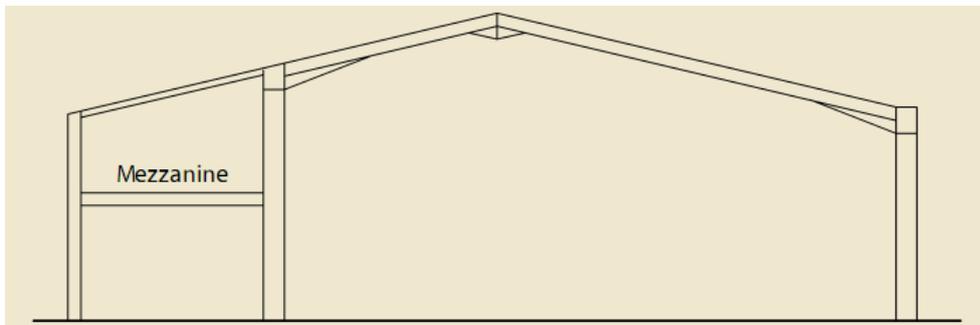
Portique avec un plancher en mezzanine extérieur
